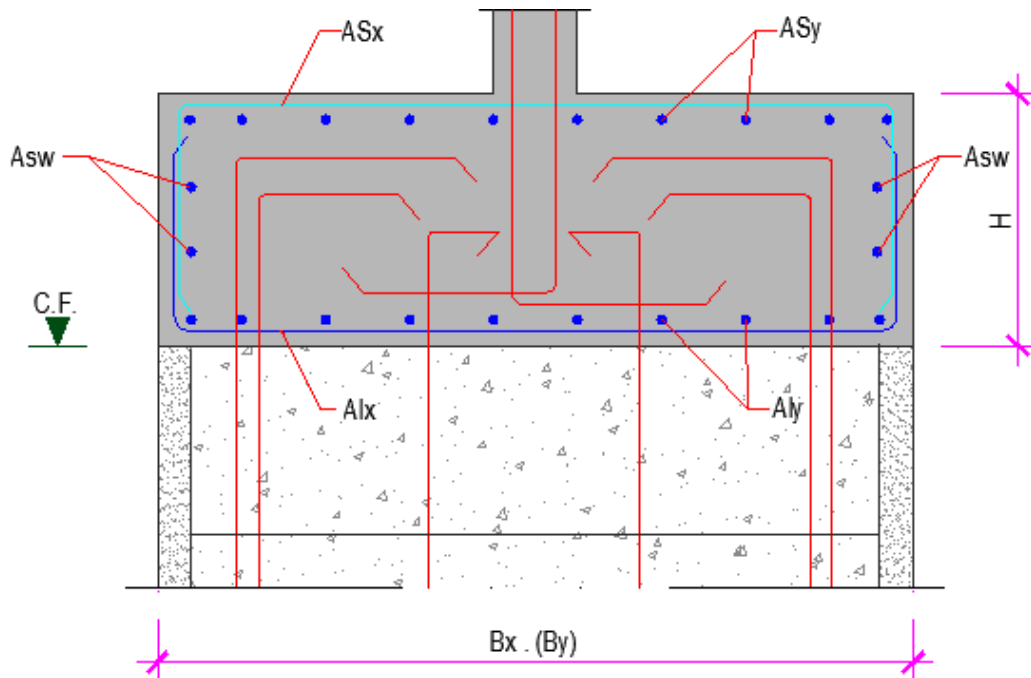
Colocação de varões no betão (Fonte: Autor)
